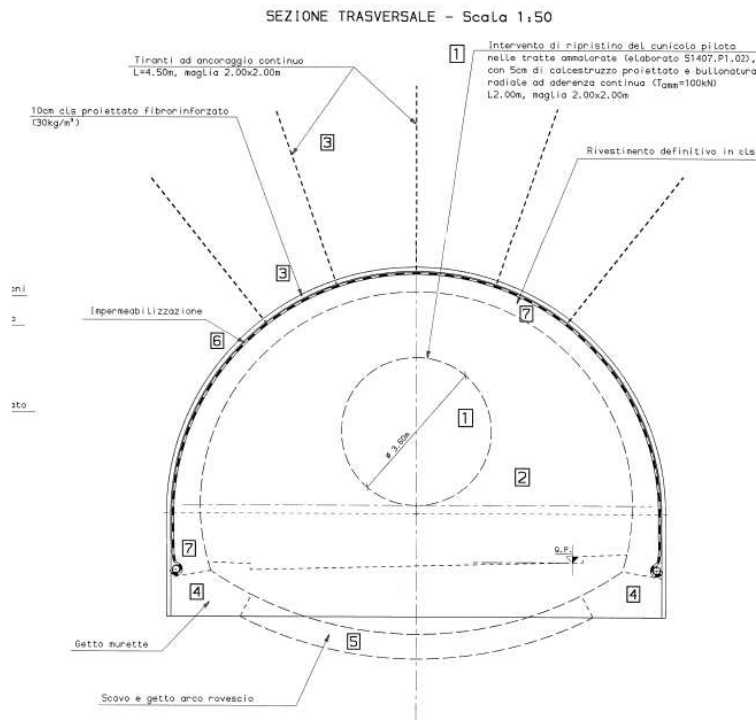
PE GEODATA 1996 – Galleria Guinza - Sezioni Tipo B – Sezione di scavo
